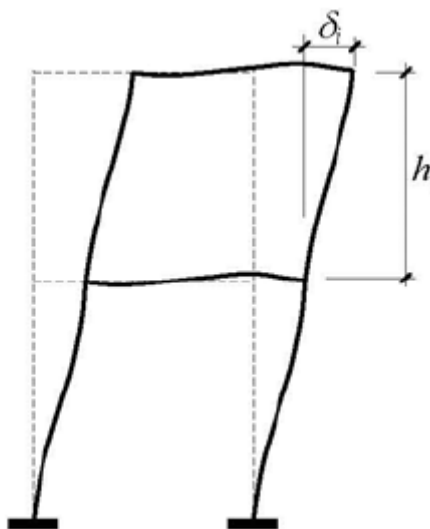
Deslocamentos horizontais em pórticos [1]
